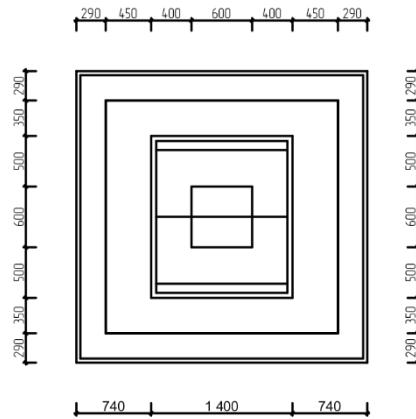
Чертёж фонтана. Вид сверху
